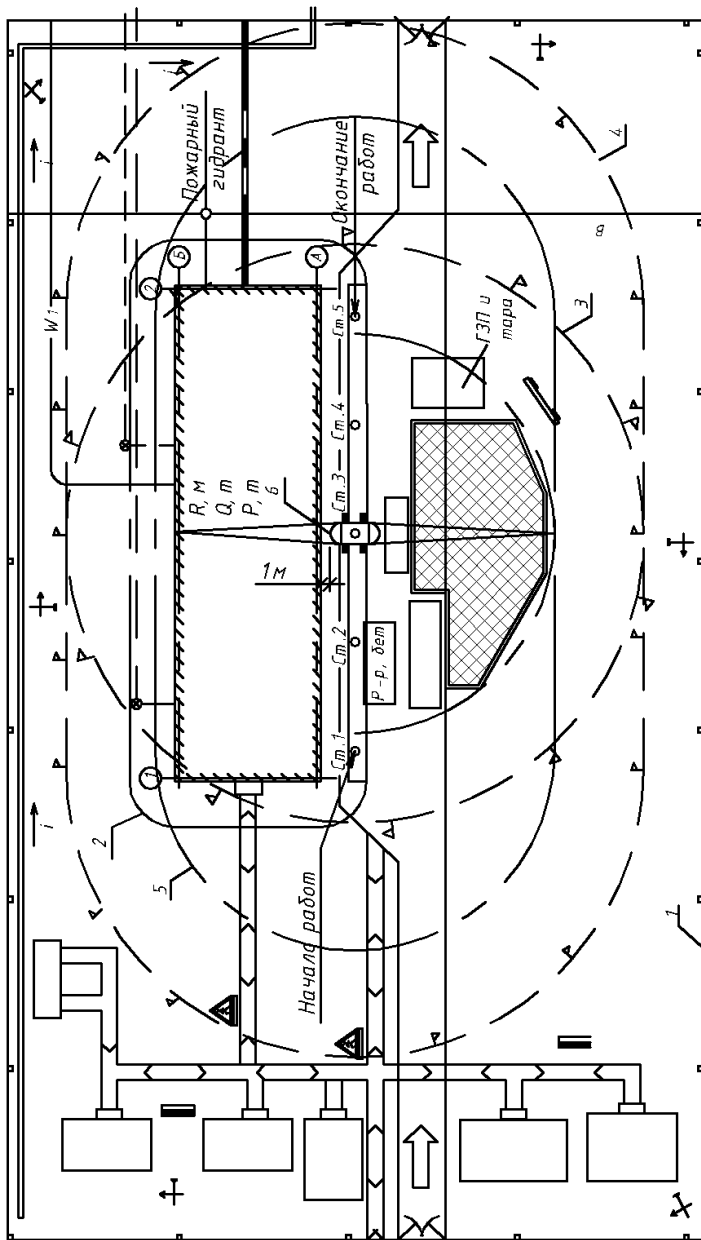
Определение границ опасной зоны при работе стрелового крана:
